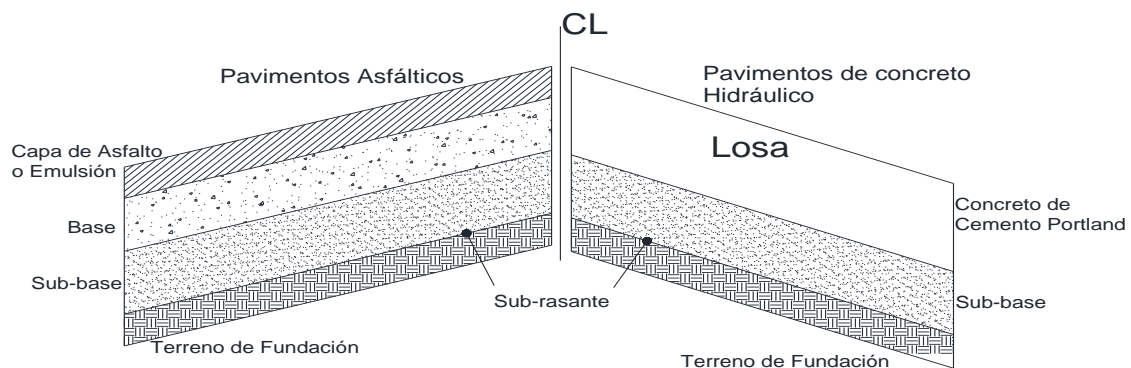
Componentes estructurales de los pavimentos Asfálticos y de Concreto Hidráulico
